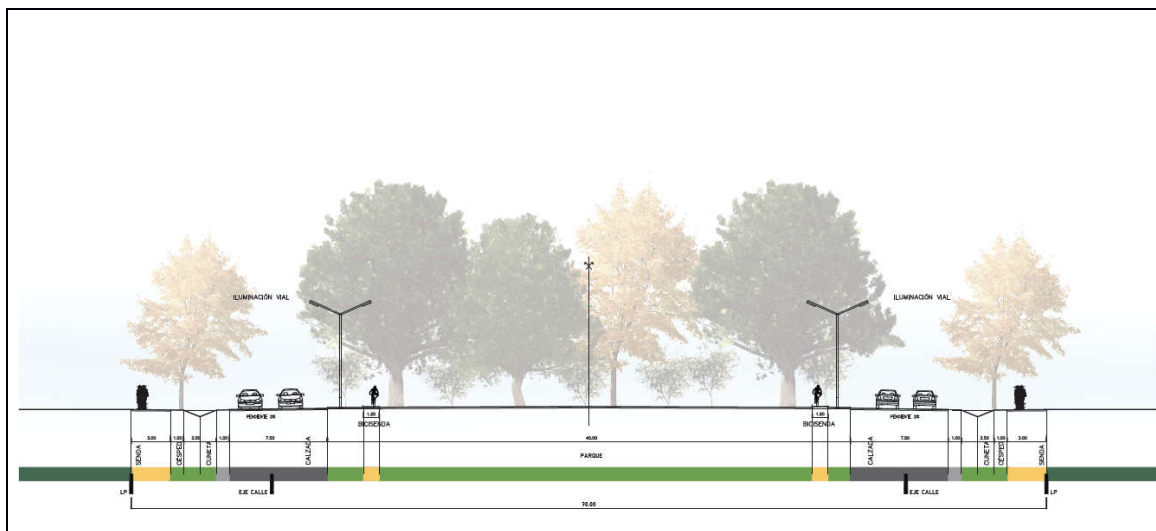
Sección Bulevar Central (lámina MO-05)
